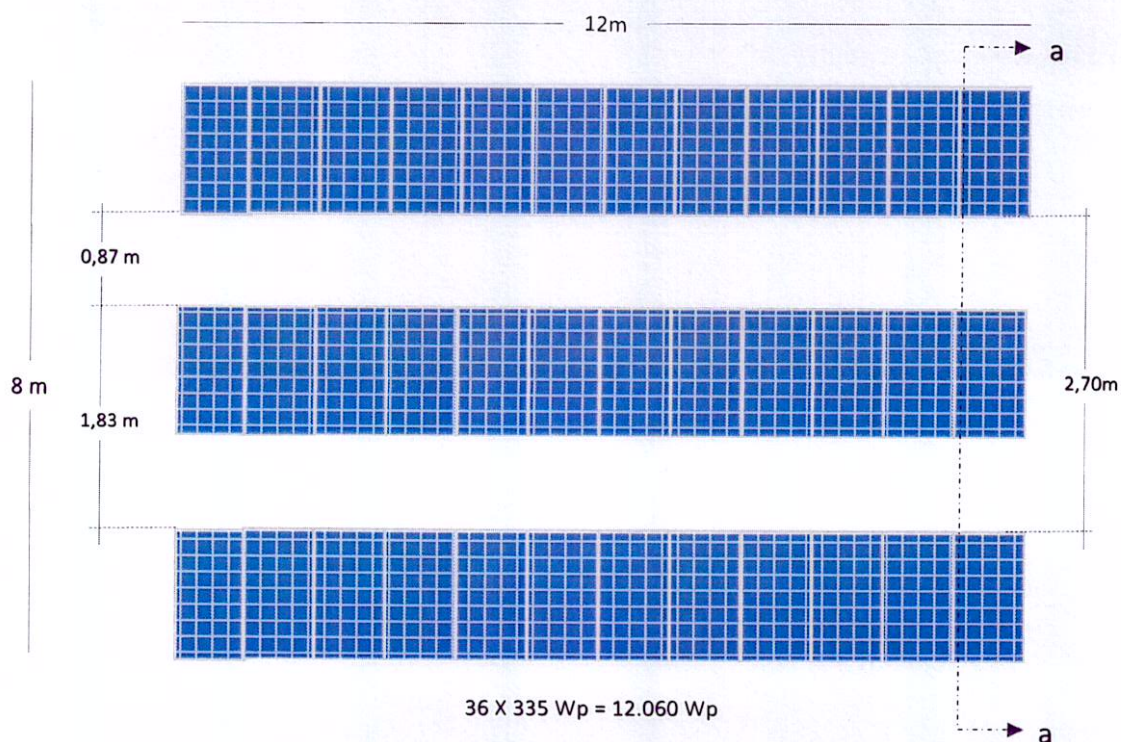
Layout dos módulos do arranjo 1 (S1)
